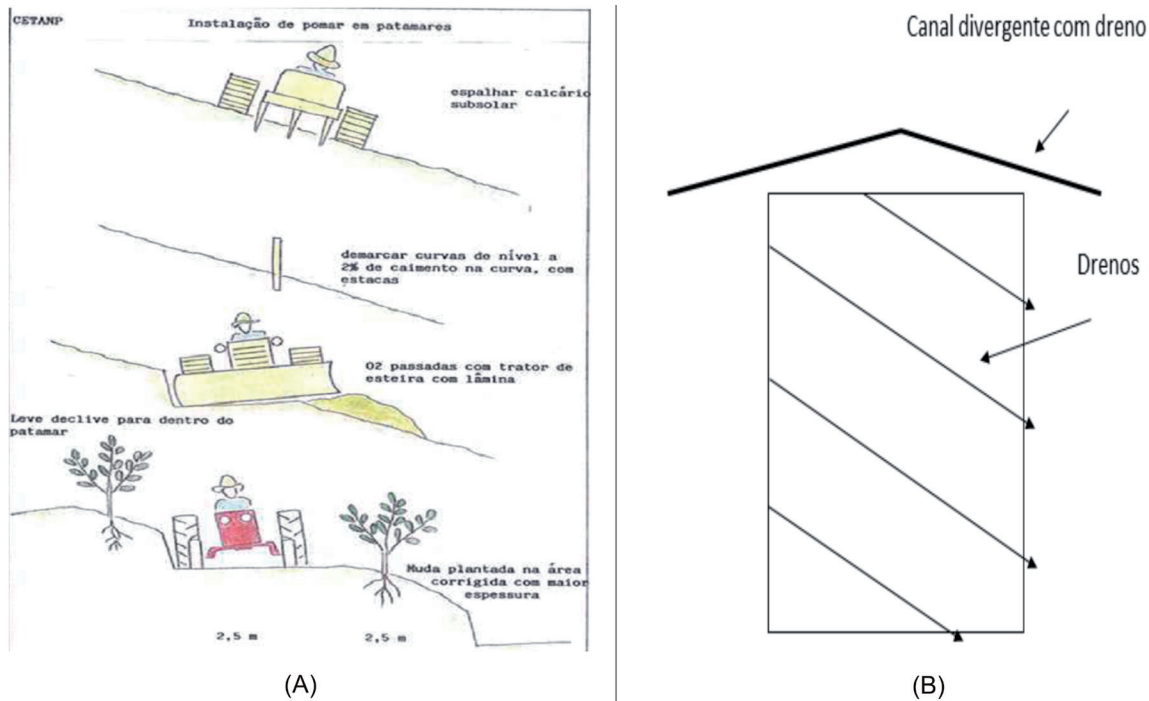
Ilustração da construção de (A) patamares e de (B) drenos
